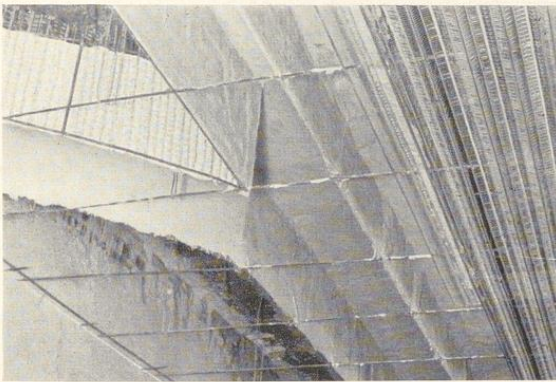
und 775. Entlüftungskanal an Eisenbeton-Hohlkörperdecke aufgehängt. Ausführung der Kanalwände und Rabitzdecke wie in Bild 773 dargestellt
